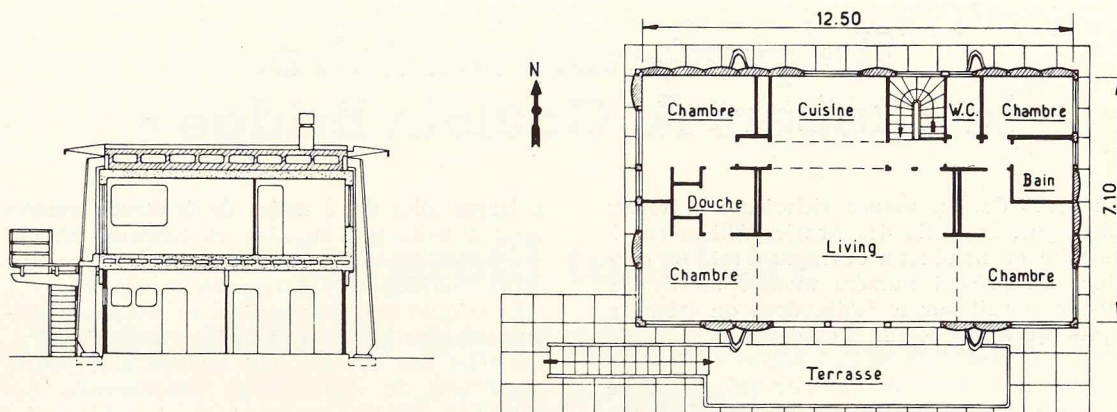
Plan et coupe transversale d'une maison standard conçue par l'architecte Lods.
